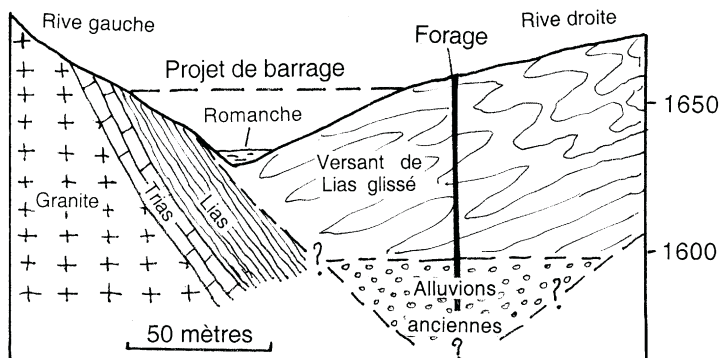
Site du projet de barrage de Villar-d'Arène (Hautes-Alpes).
